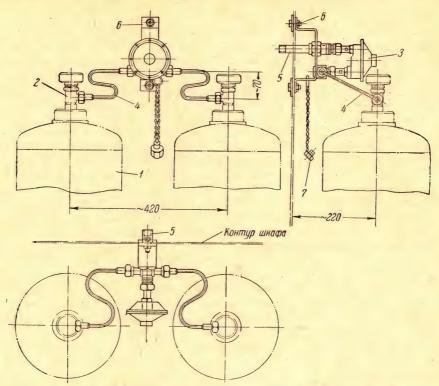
Обвязка двух баллонов, установленных в металлическом шкафу: 1 — баллон; 2 — вентиль; 3 — регулятор давления; 4 — трубки газа высокого давления до $16~\kappa\Gamma/c\text{M}^2$; 5 — расходная трубка низкого давления 270-300~мм. вод. ст.; 6 — крепление регулятора к стенке шкафа; 7 — заглушка.
